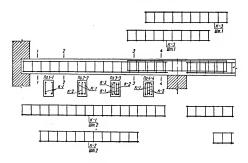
93. Схема армирования отдельных много пролетных балок.
